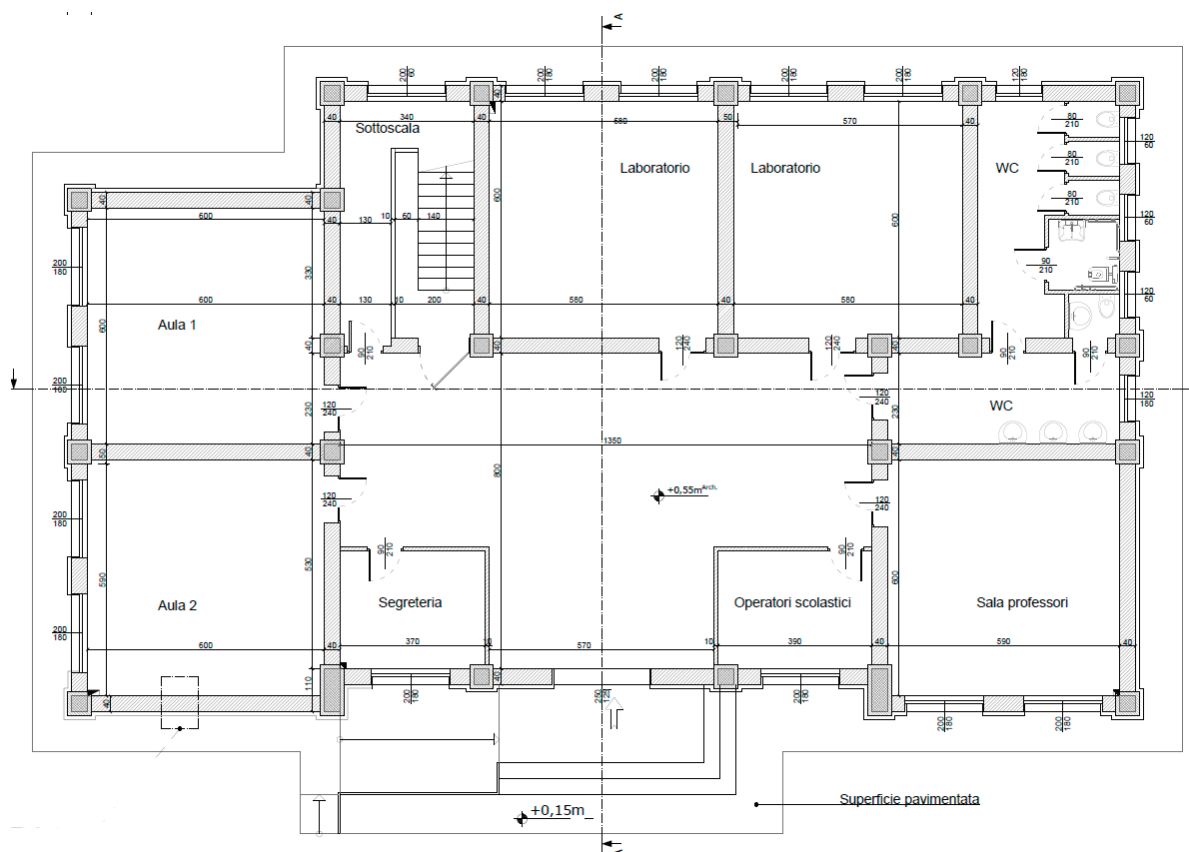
Pianta Piano Terra- Stato Futuro
